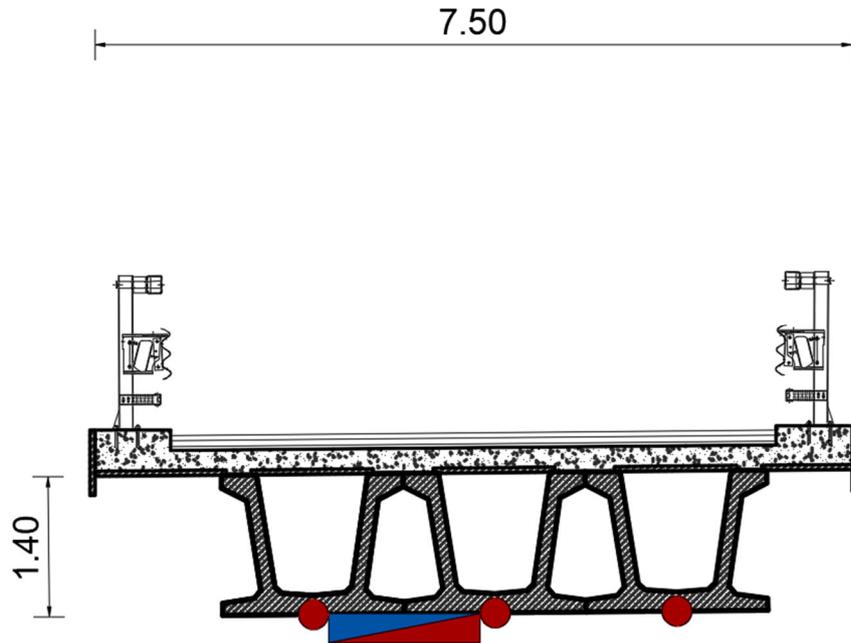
Ubicazione sensori su impalcato a 3 travi (sezione trasversale VI04)
